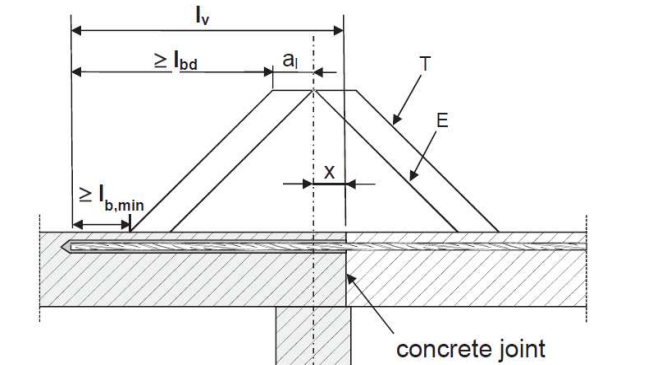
Ancrage en extrémité de dalles ou de poutres, en appui simple
